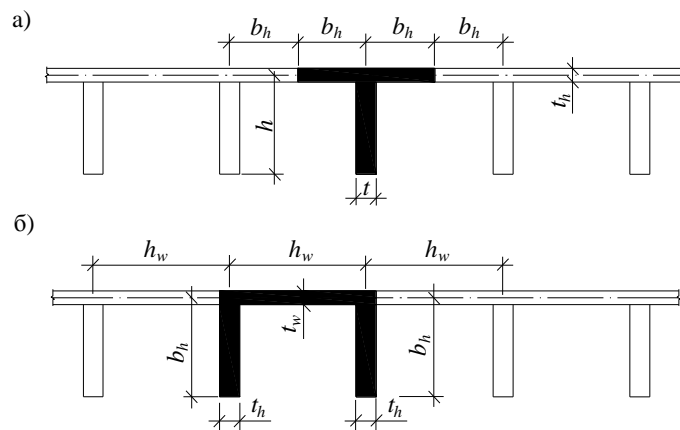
Схемы расчетных сечений пластинок ортотропных плит
